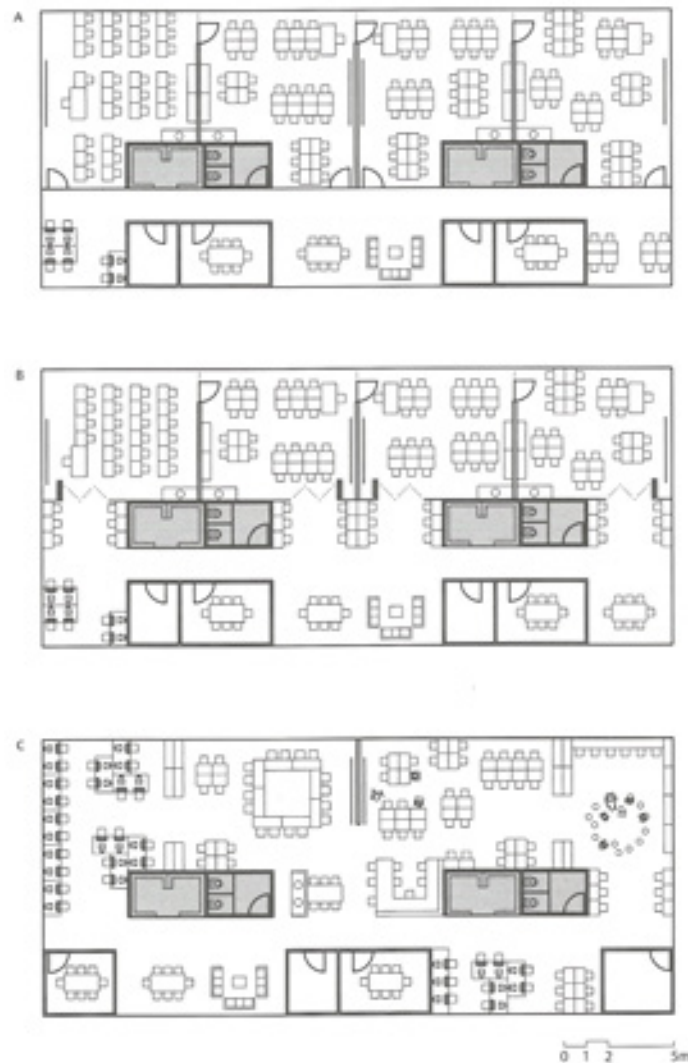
Artikulierte Grundrisstypen, Architekt Herman Hertzberger
